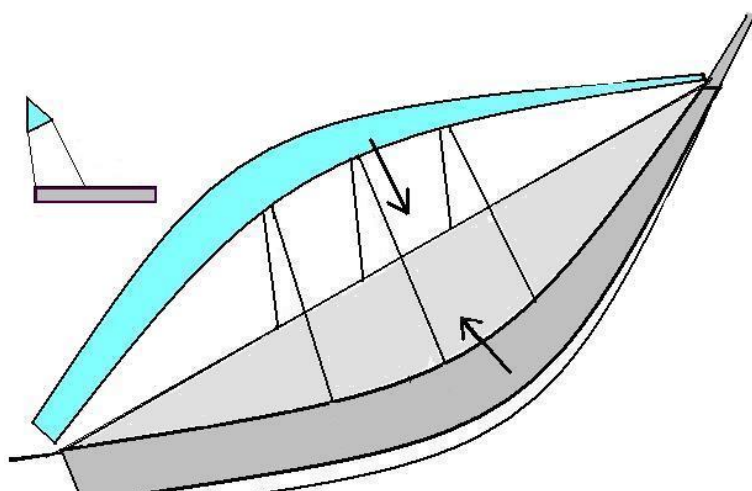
Alessandria: il nuovo Ponte Cittadella, schema strutturale.
